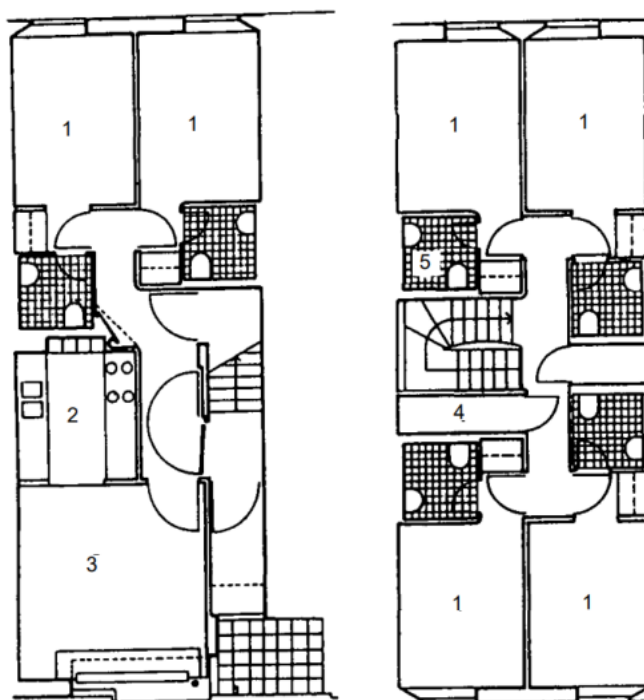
Planta do Pavimento Térreo, à esquerda. Planta do Pavimento Tipo, à direita. Constable Terrace, University of East Anglia, Reino Unido
